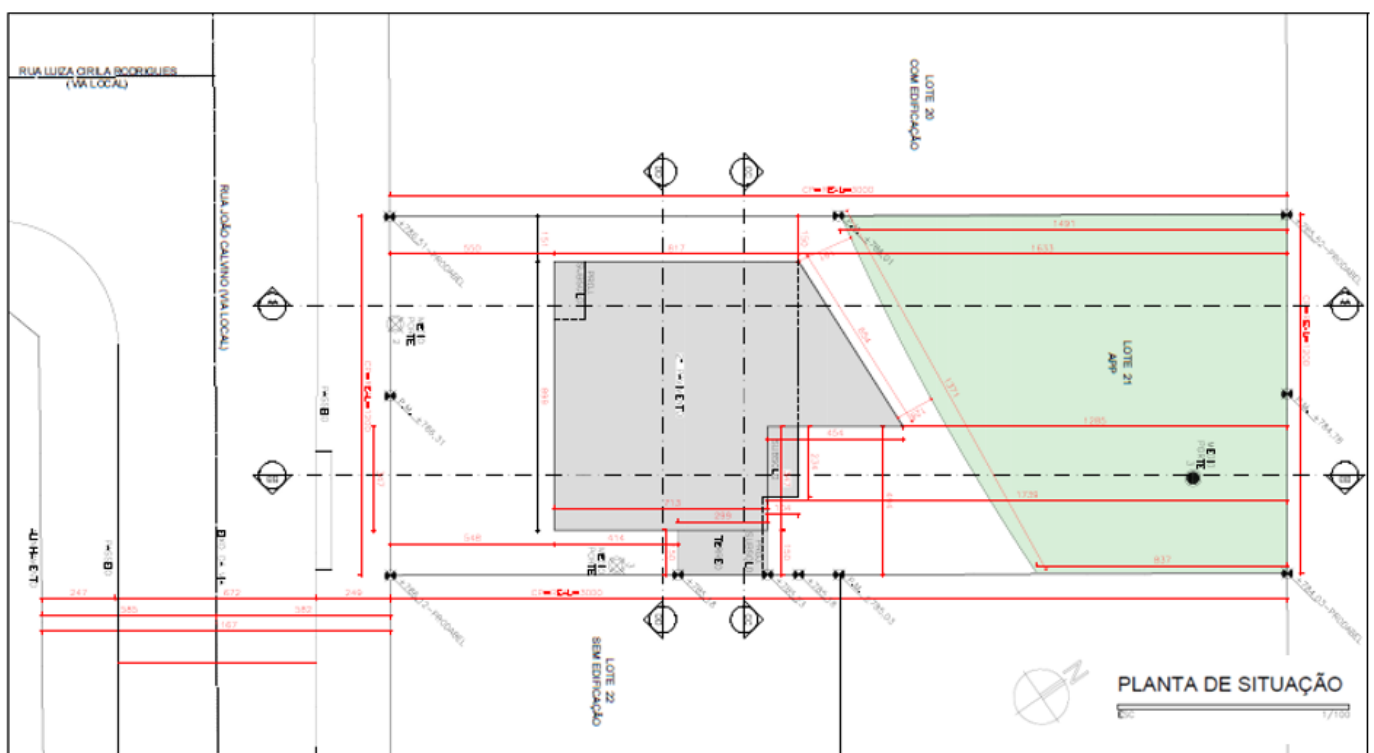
Planta de situação do empreendimento. Fonte: Requerente / Adaptado SMMA, 2026.
